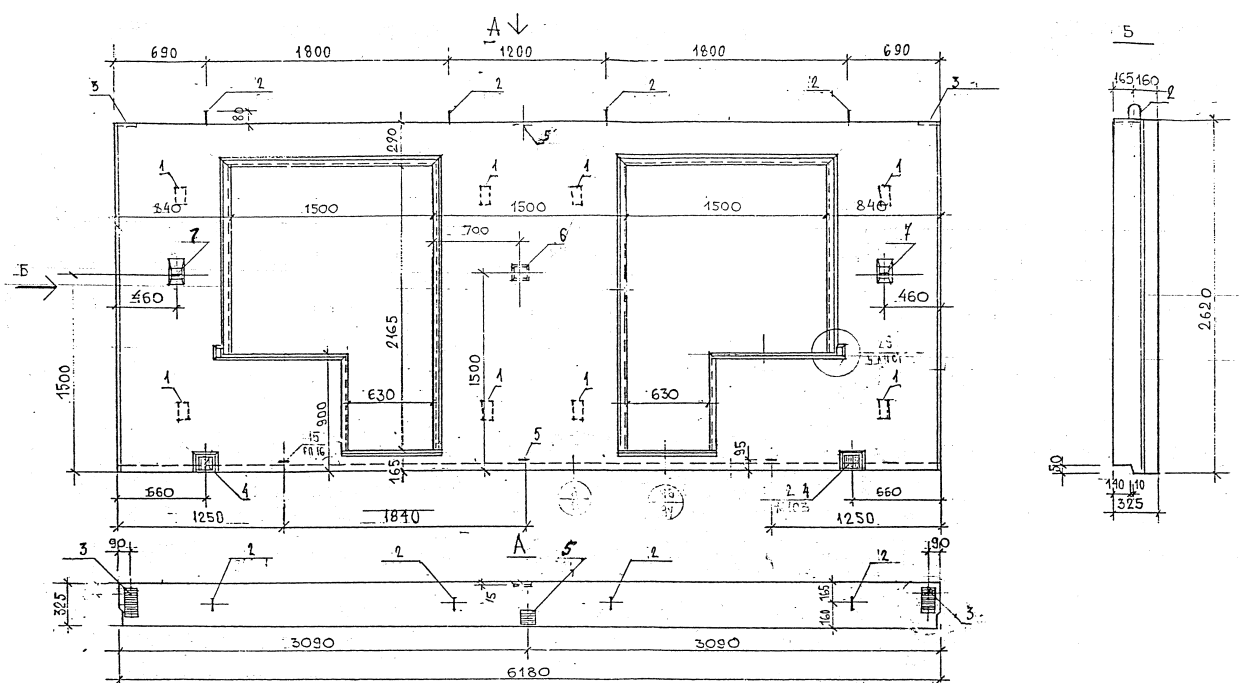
Трехслойная бетонная панель с бетонными шпоночными связями между слоями: 1 - бетонная шпонка; 2 - подъемная петля; 3 и 4 - закладные детали; 5 и 6 - связевые элементы; 7 - петлевой выпуск
